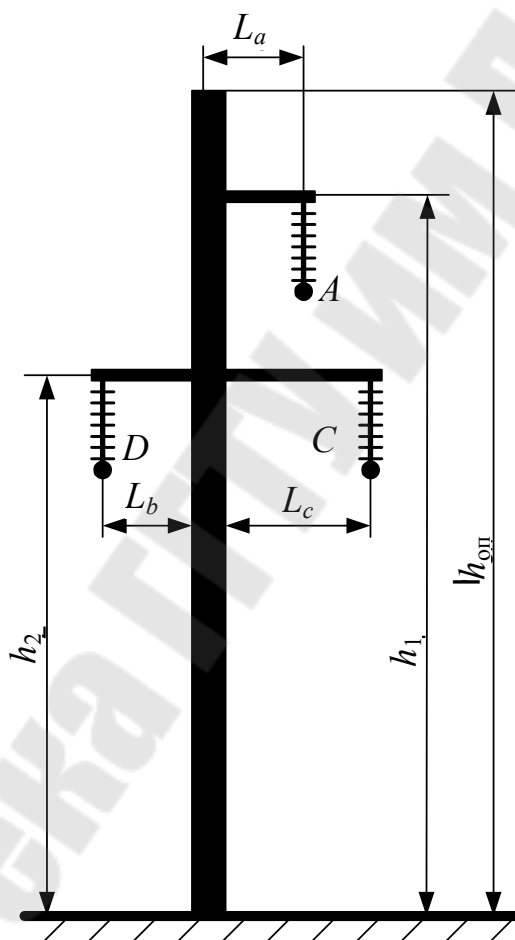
Геометрия железобетонной опоры 110 кВ
